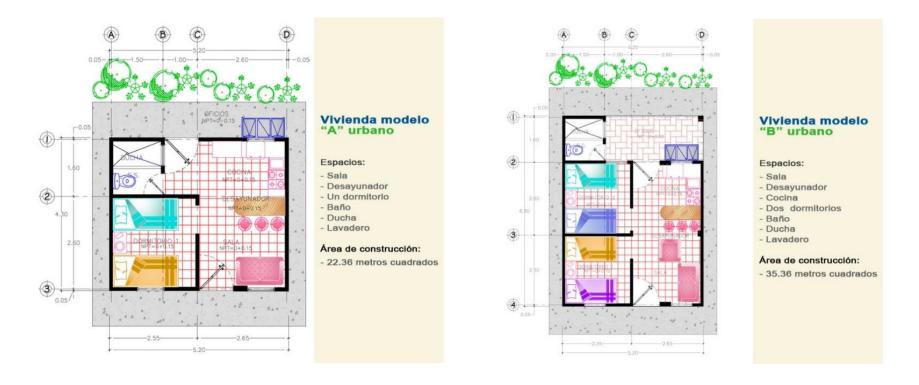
, Plantas Arquitectónicas tipo A y tipo B
